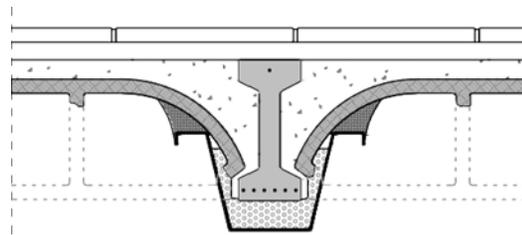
SOLUCIONE CONSTRUCTIVA
